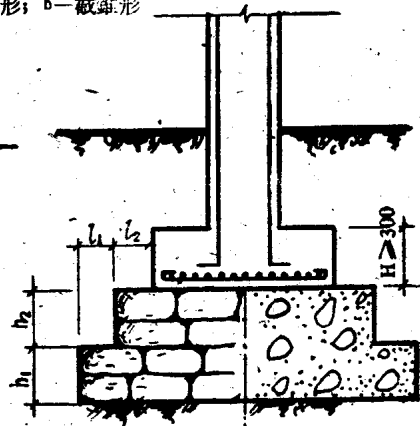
用毛石或毛石混凝土作底座的钢筋混凝土基础 (单位: mm)
